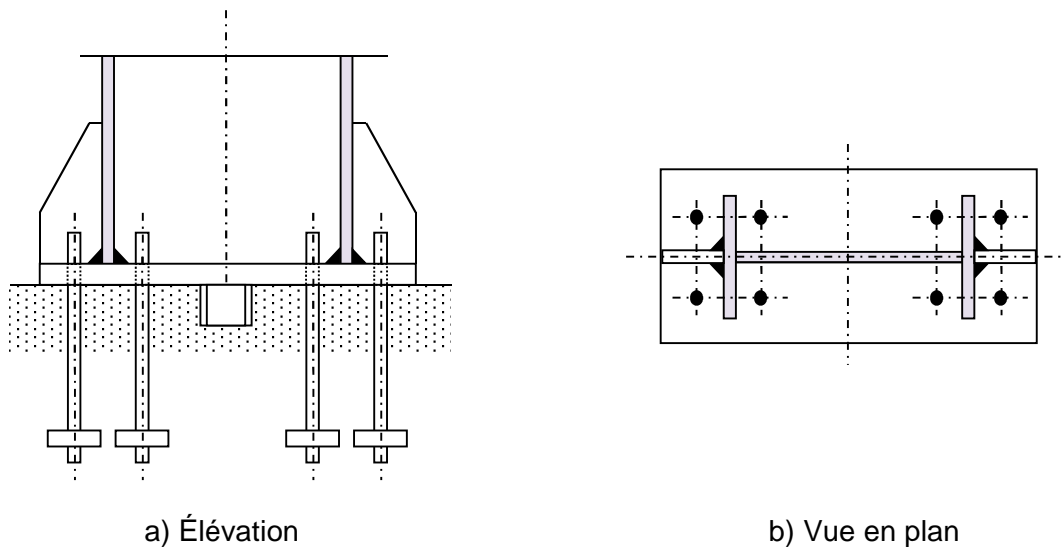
Exemple d'encastrement avec platine d'extrémité raidie.
